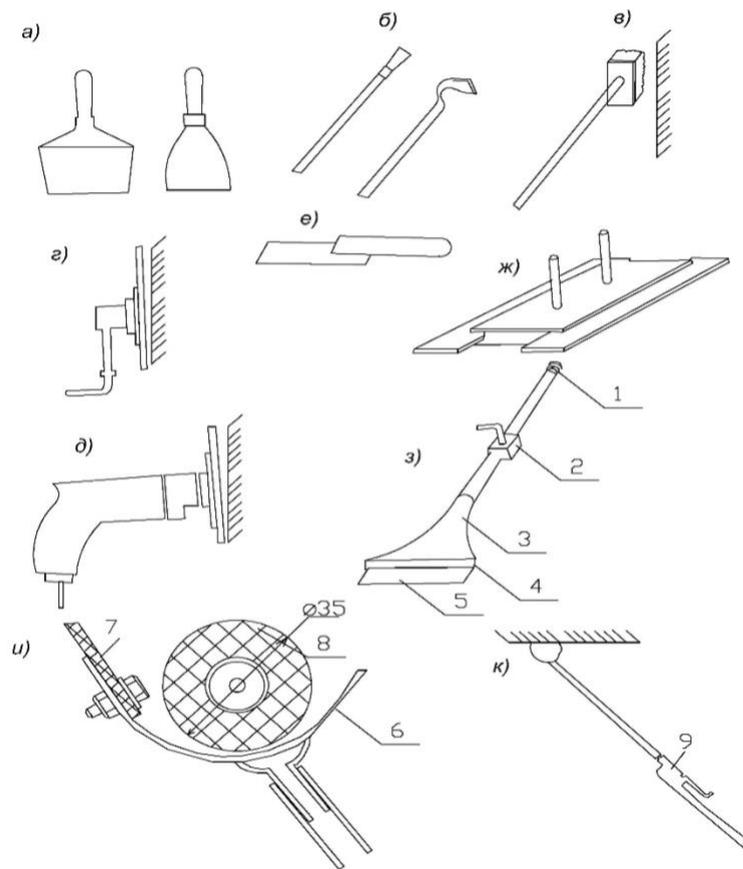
Инструменты и аппараты для подготовки поверхностей под покраску: а) – стальные шпатели; б) – скребки; в) – щетка; г) – затирочно-шлифовальная машина пневматическая; д) – то же, электрическая; е) – малярный нож; ж) – шпатель-полутерок; з) – механизированный шпатель; и),к) – схемы процесса выравнивания поверхности механизированным шпателем-валиком; 1 – штуцер; 2 – запорный кран; 3 – корпус; 4 – щель для шпатлевки; 5 – резиновая пластинка; 6 – ванночка; 7 – разравнивающая полоска; 8 – валик; 9 – клапан
